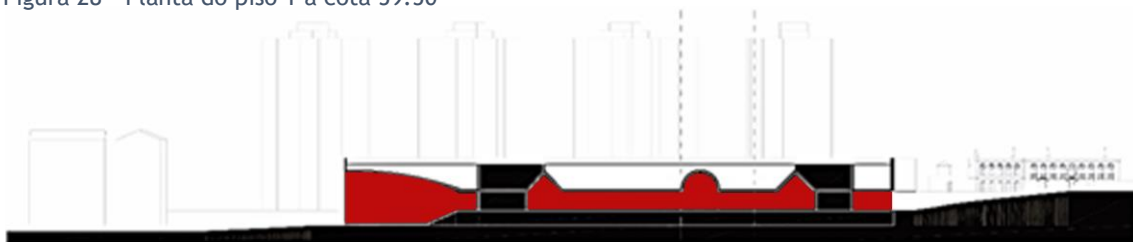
Corte longitudinal esquemático das formas desenhadas no teto
